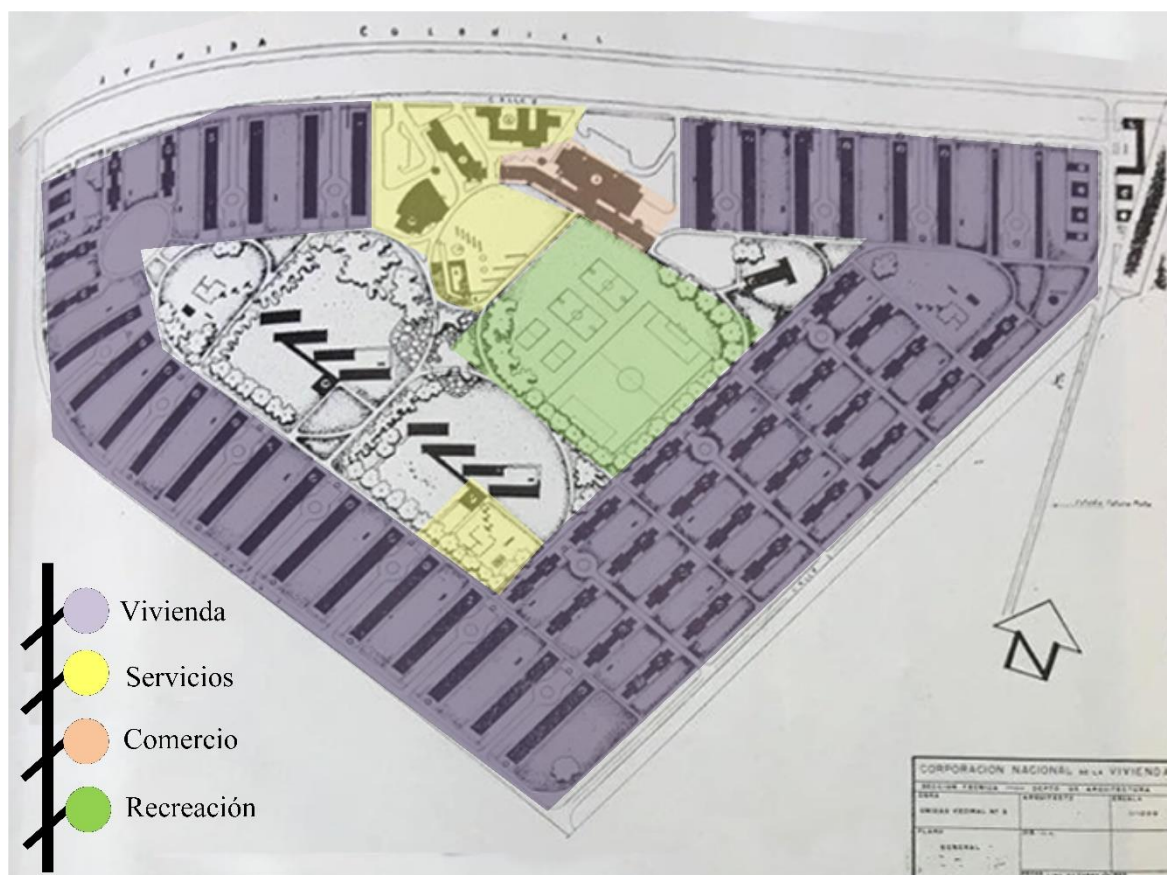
Planta de distribución de la Unidad Vecinal N° 3. Imagen elaborada a partir de la planta publicada en la revista *El arquitecto peruano* (1949).
